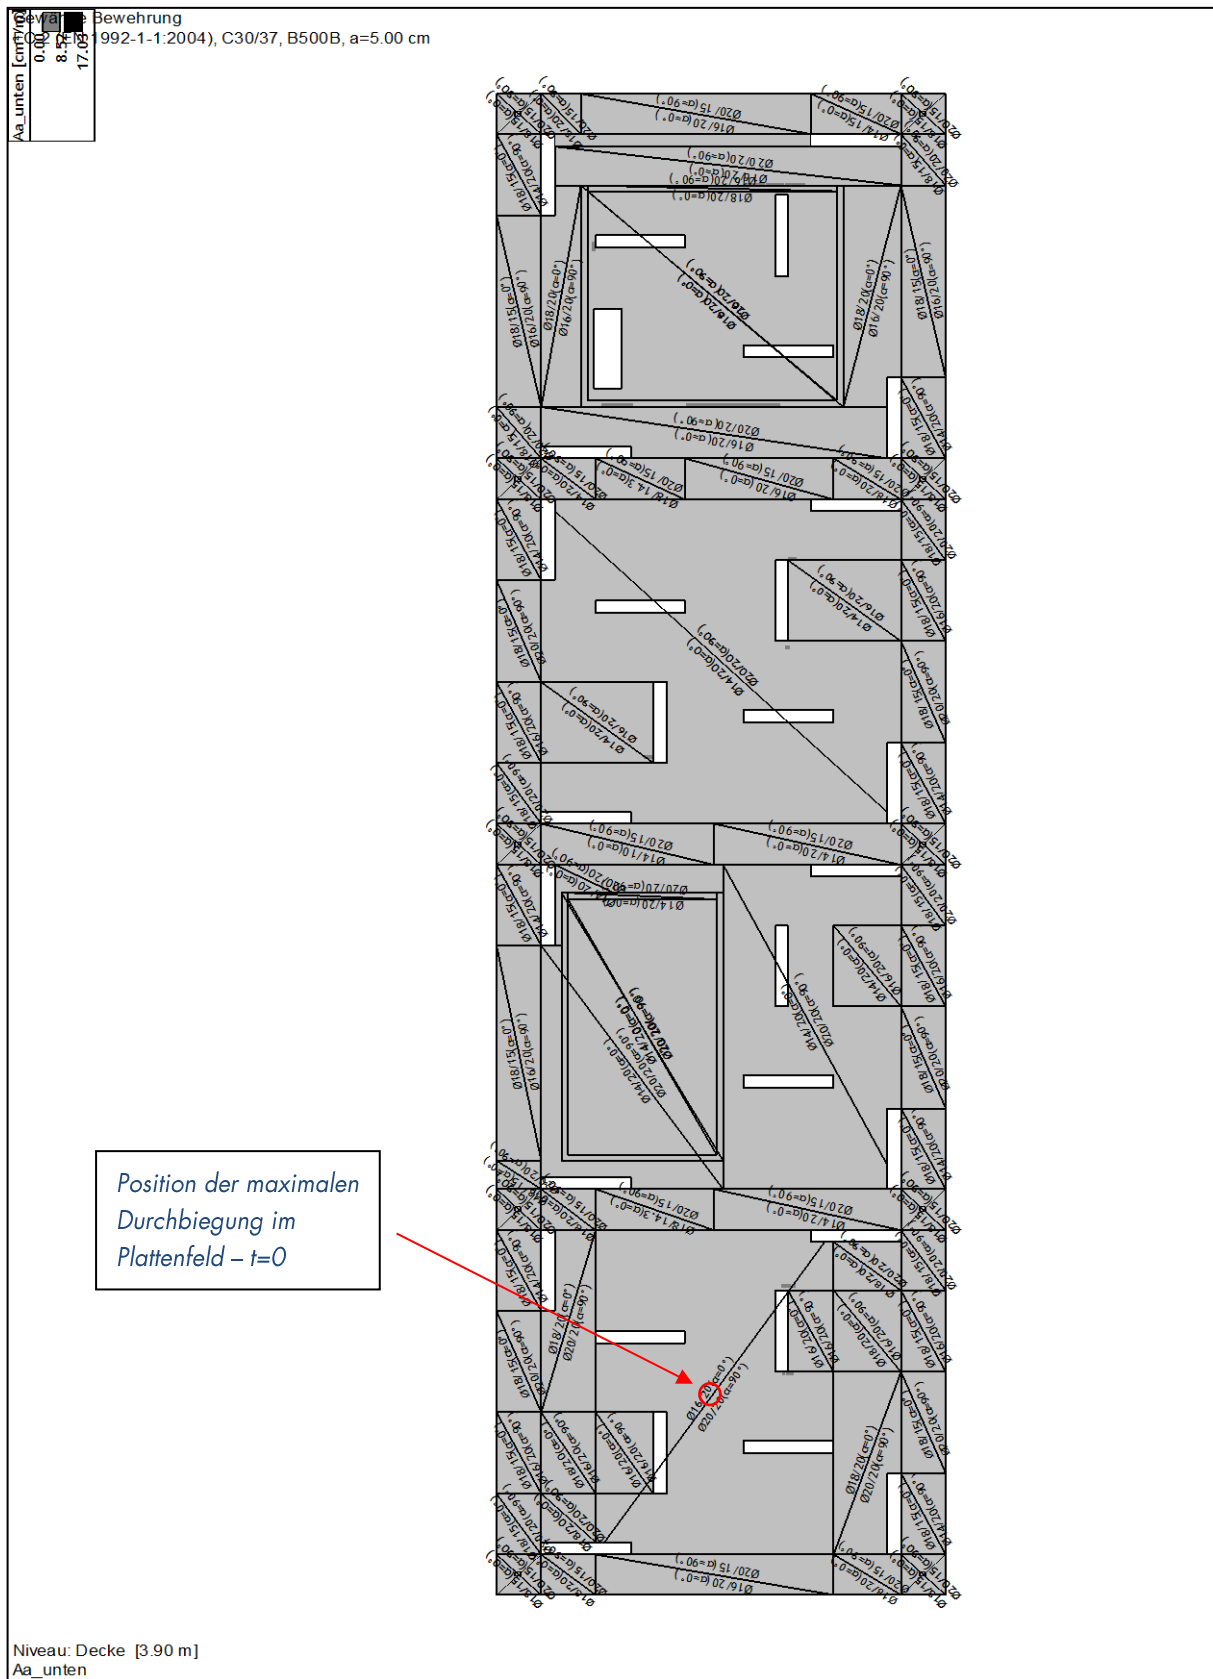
Bestehende untere Bewehrung – Dachplatte
